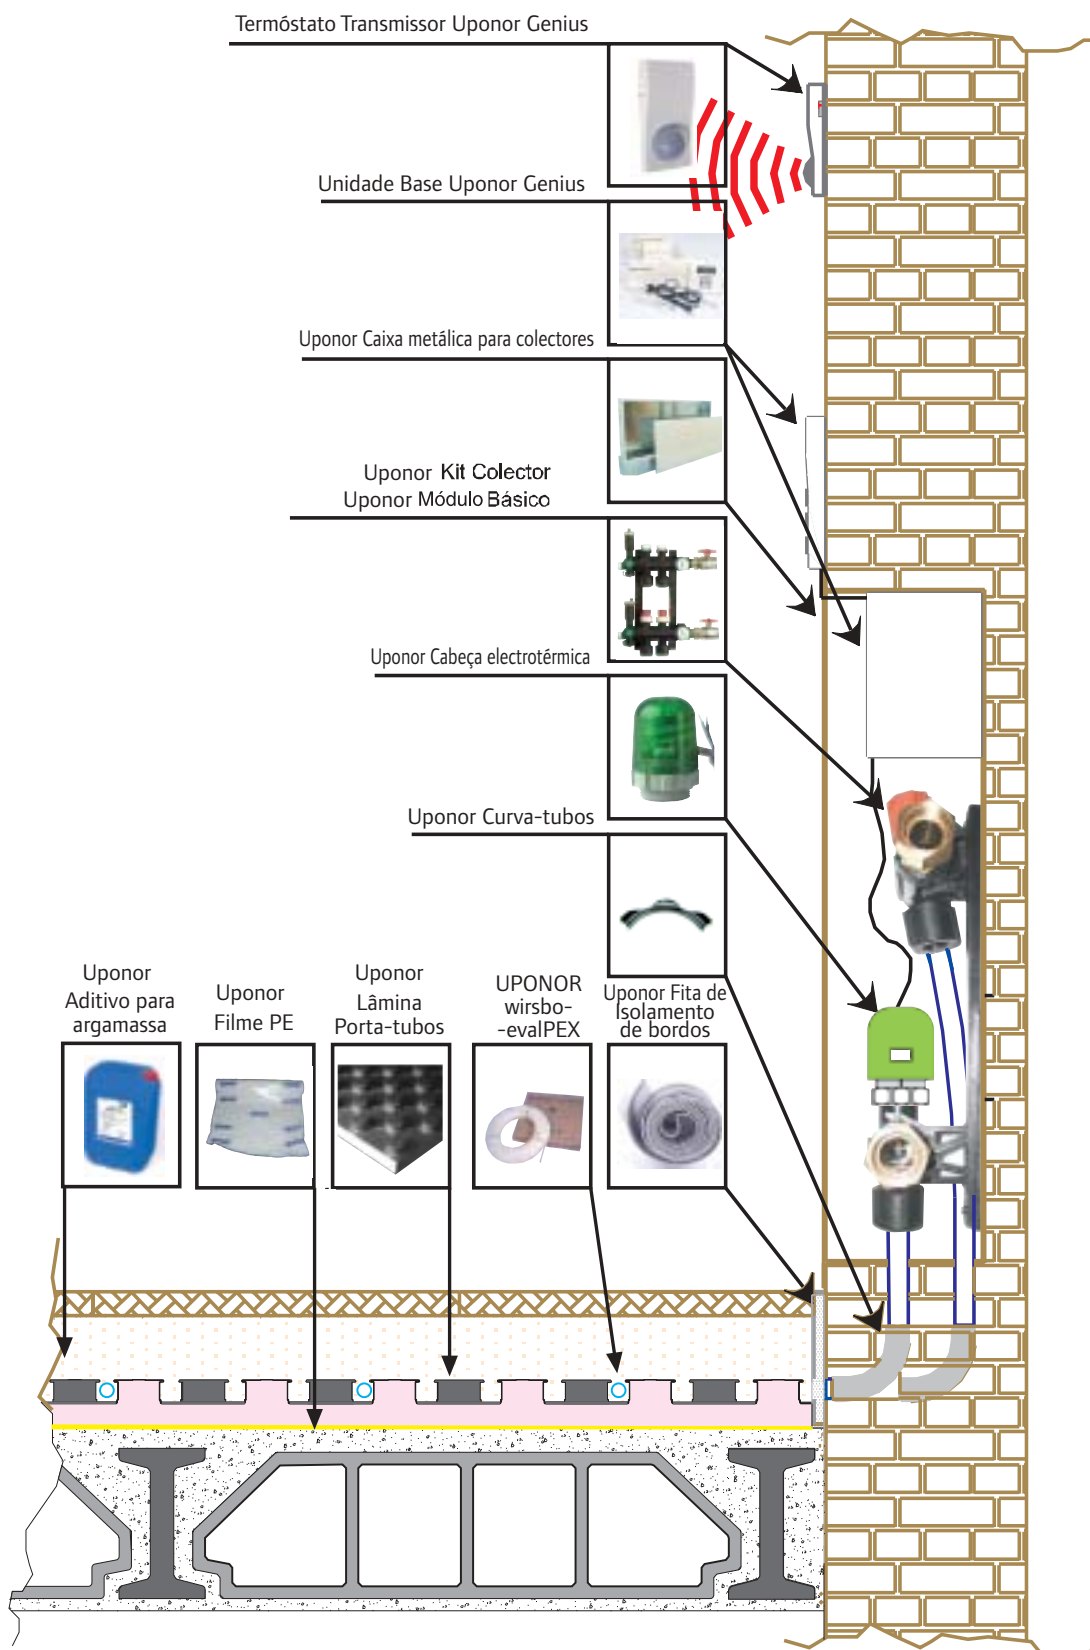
Sistema tradicional UPONOR de aquecimento por chão radiante
